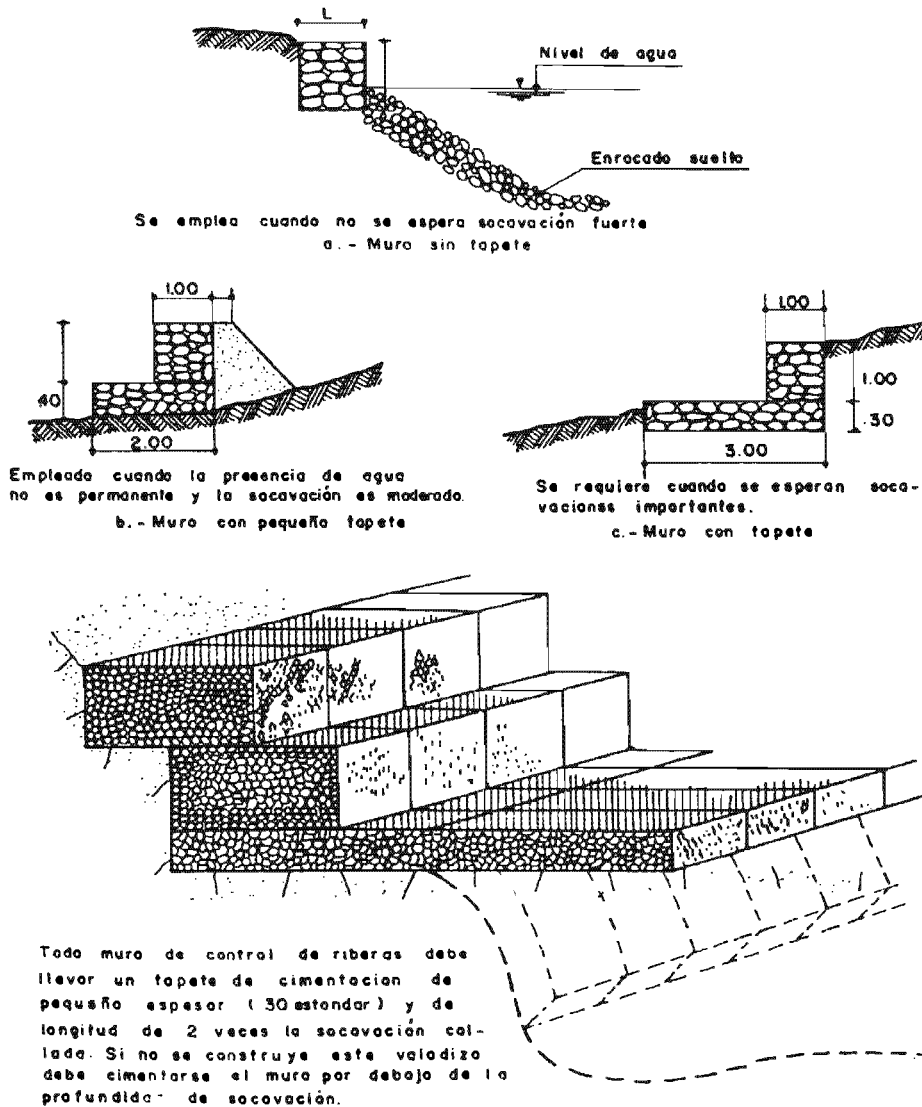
Muros gaviones para la protección de las riberas de los ríos.
